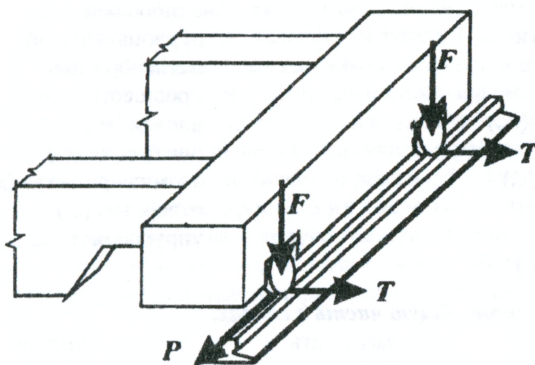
Кран и компоненты крановой нагрузки (вертикальные – F , горизонтальные поперечные – T , продольные – P нагрузки)
